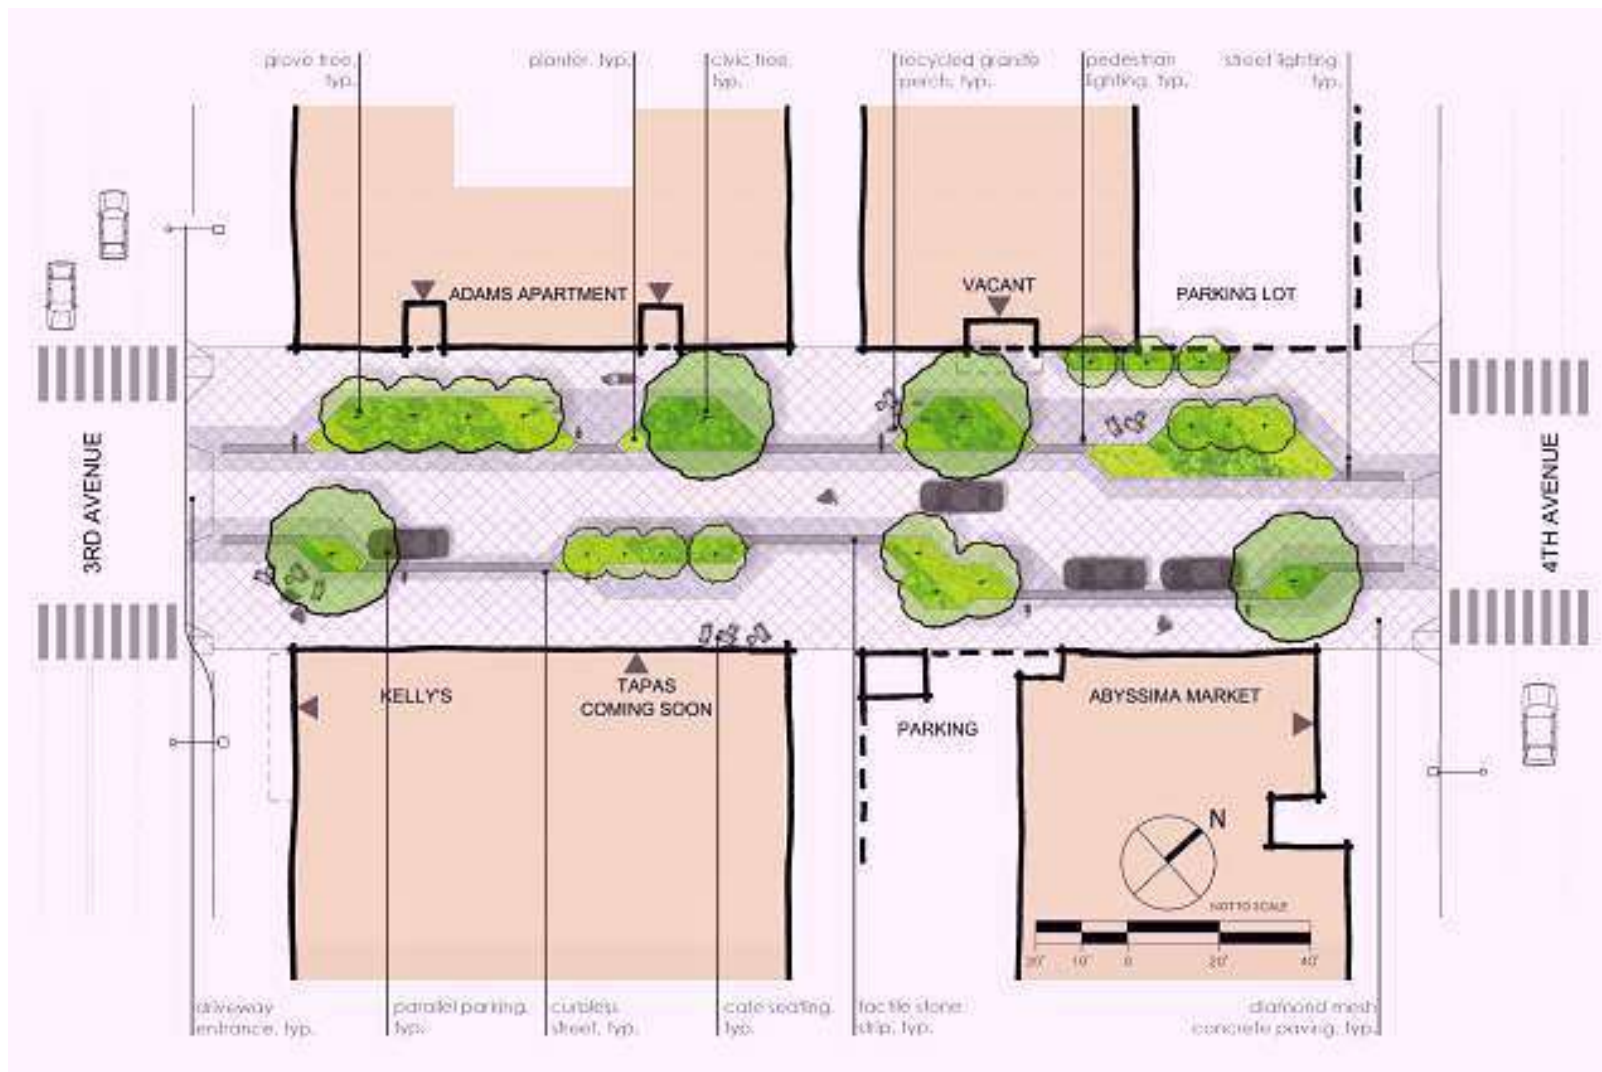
Planta de implantação do projeto de requalificação da Bell Street Park, em Seattle. Fonte: NACTO (2014), disponível em: <<https://nacto.org/case-study/bell-street-park-seattle/>> Acesso em 14 mar. 2022.
